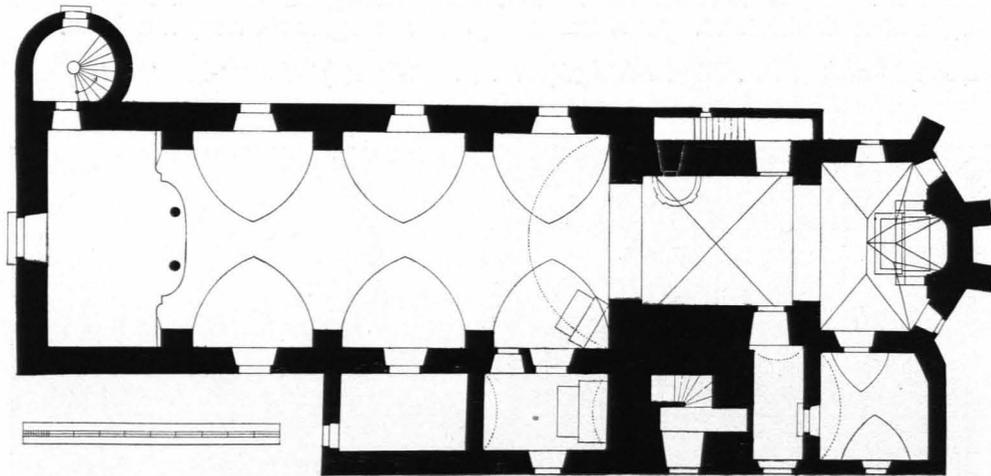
a Röhrenbach, Pfarrkirche, Grundriß 1 : 300 (S. 466)
